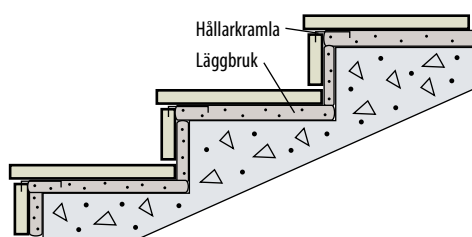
Beklädnadstrappa monterad i bruk på stomme av betong. Typkonstruktion T4
